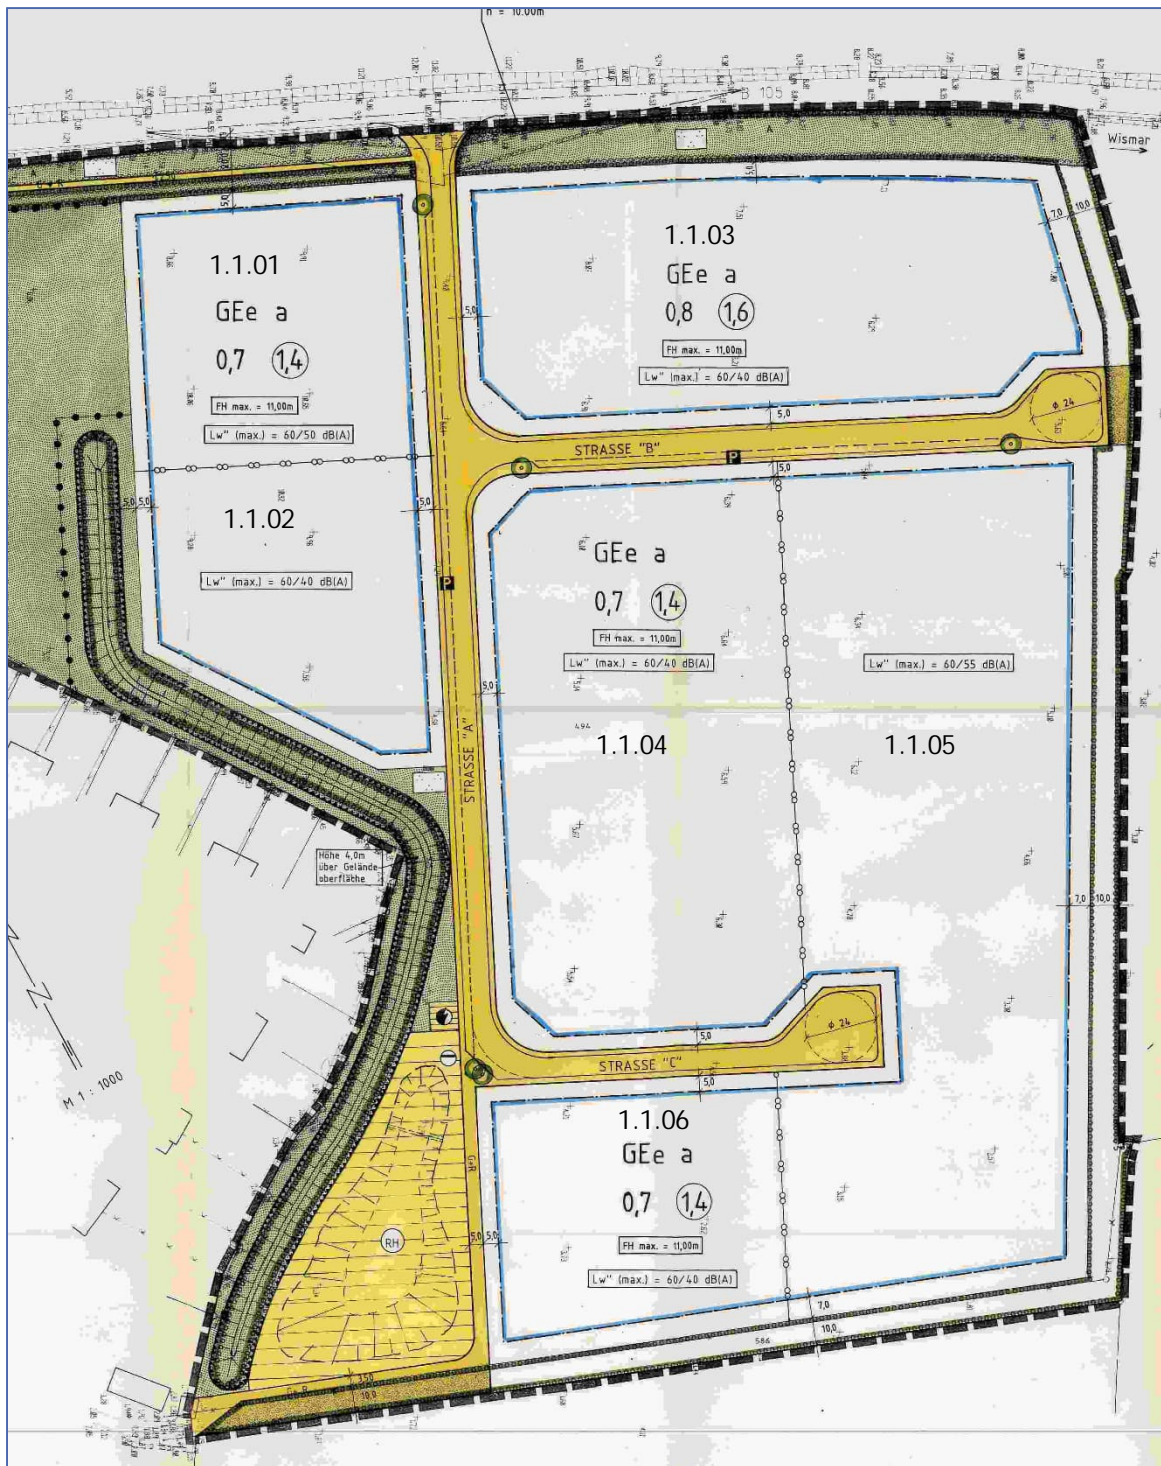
Ausschnitt B-Plan Nr. 1 mit maßgeblichen Festsetzungen
